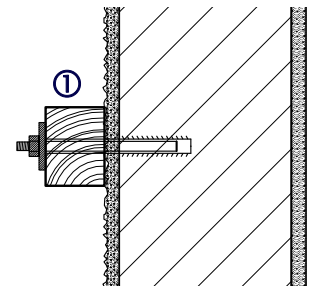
Erläuterungen zum Konstruktionsaufbau (Vertikalschnitte)
